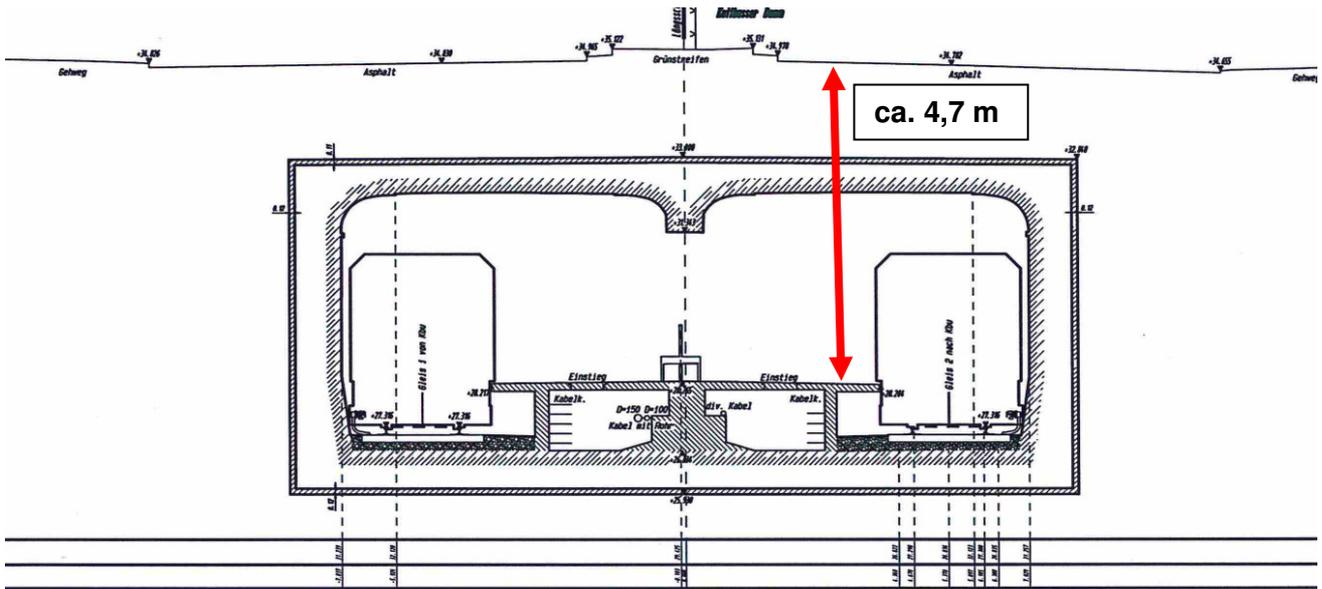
Schnitt durch den U-Bahn station Schönleinstraße mit Darstellung der Tiefe des Bahnsteigs unter der Straßenebene
